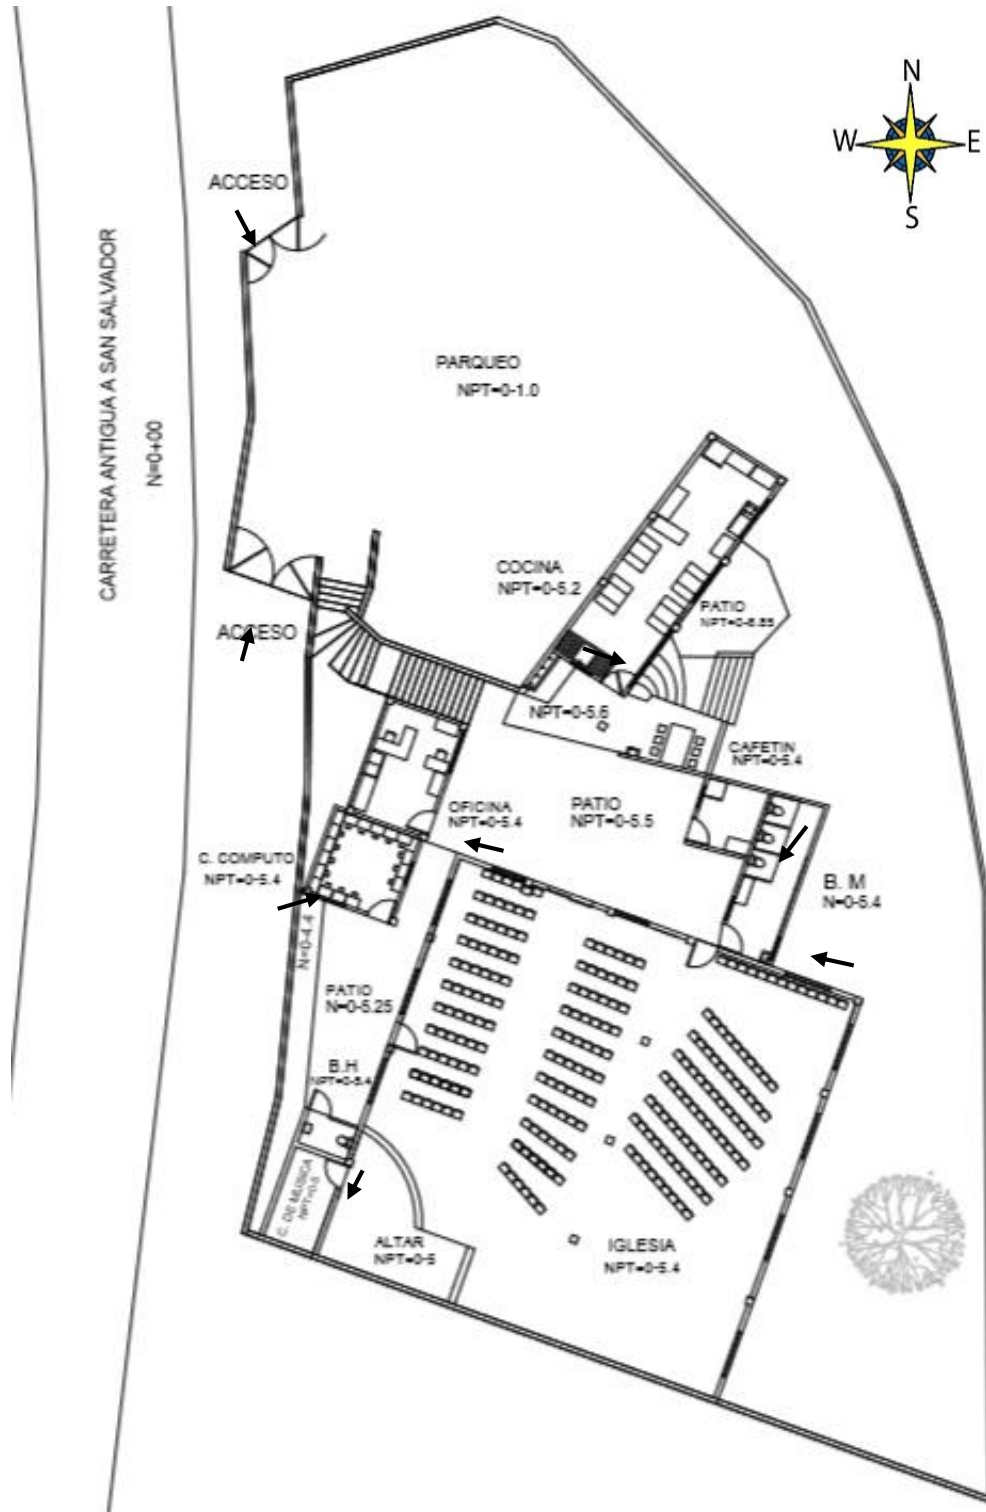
Plano de conjunto y planta arquitectónica media segundo nivel.
